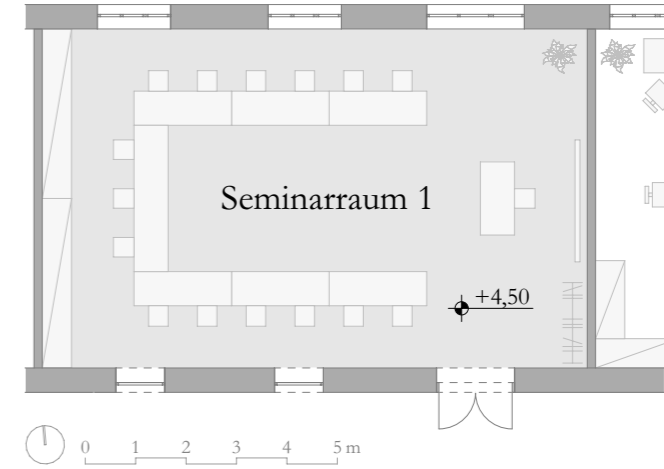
Grundriss Obergeschoss (Detail Seminarräume) M 1:150
